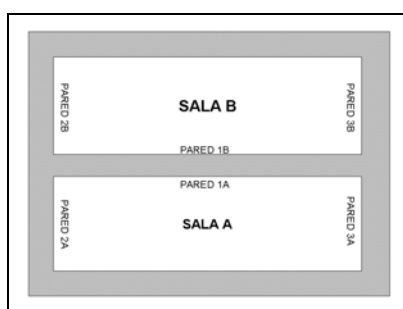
Vista en planta de las salas de ensayo y notación utilizada para cada uno de los paramentos
